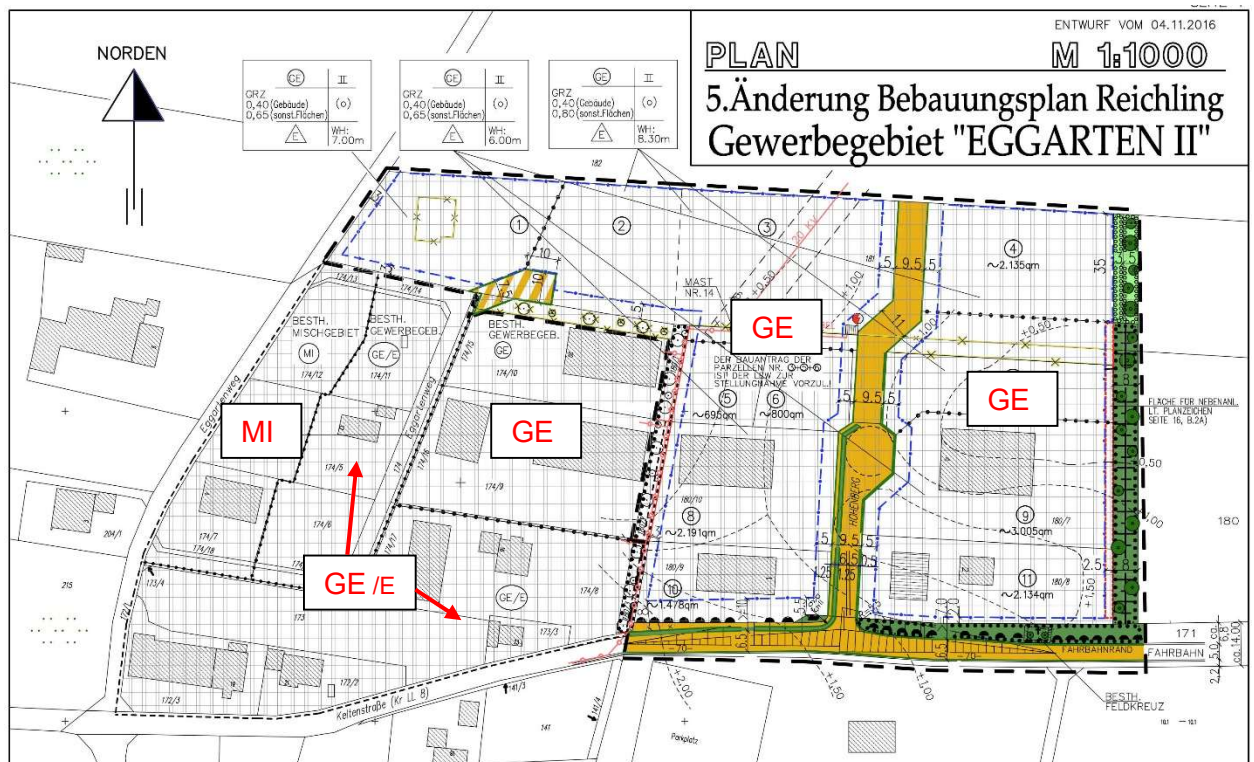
Planzeichnung 5.Änderung des Gewerbegebietes „Eggarten II“, links davon BPL „Eggarten“ mit Mischgebiet MI, Gewerbeflächen GE und eingeschränktes GE (GE-e)
